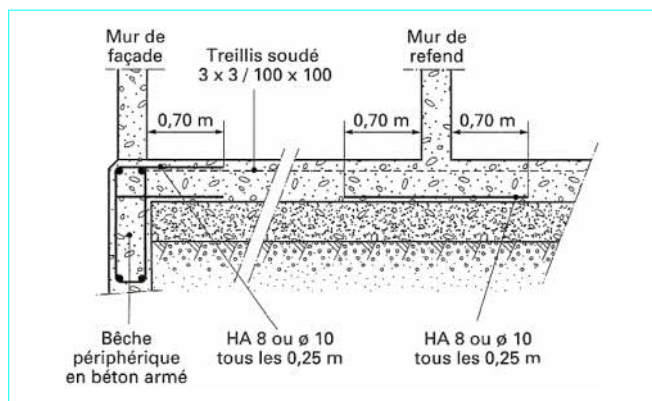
Armatures de dallage supportant murs de façade et de refend
